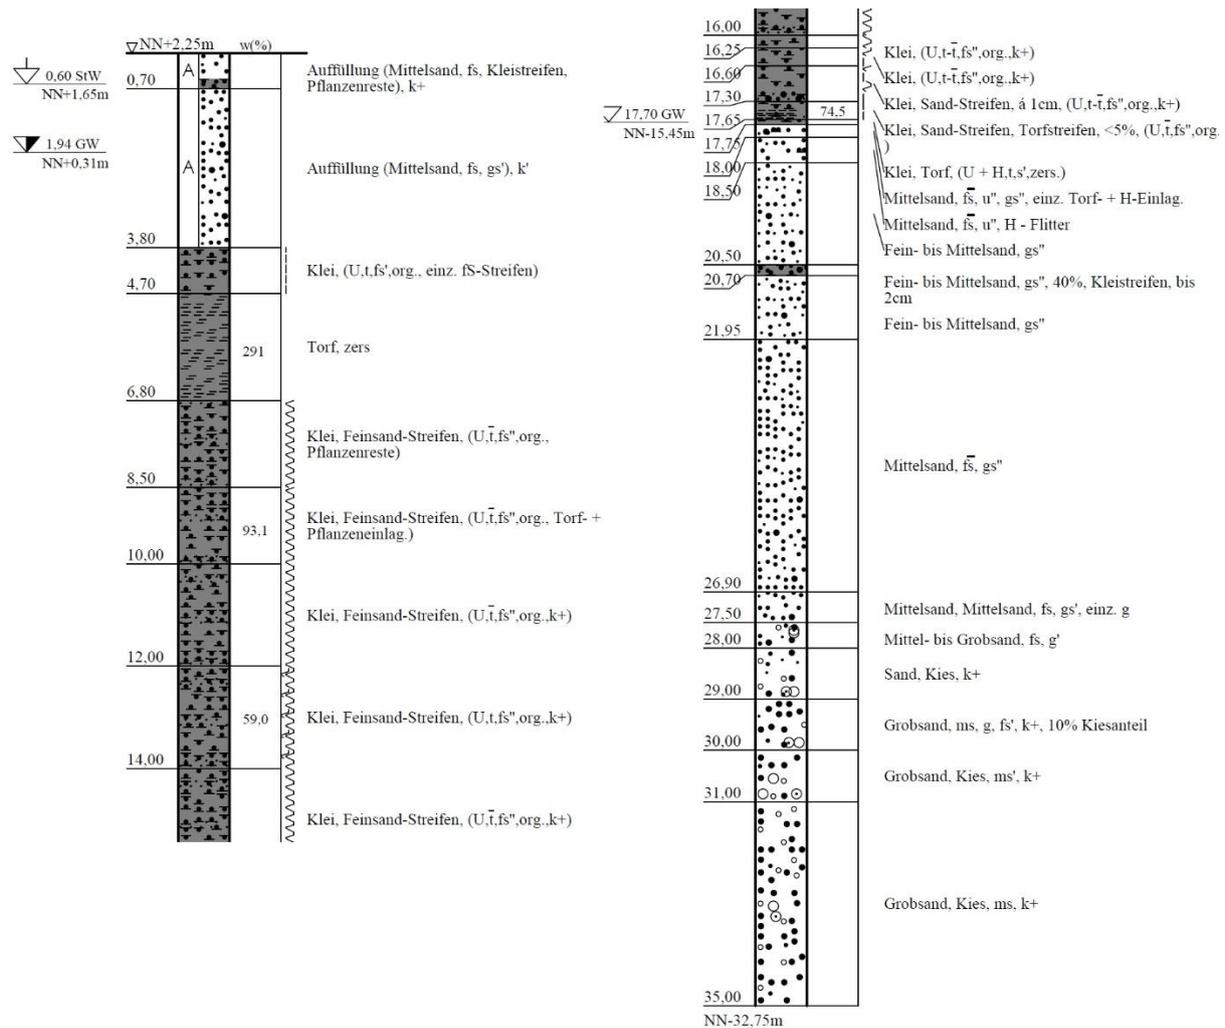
Profilaufbau mit Grund- und Stauwasserständen
